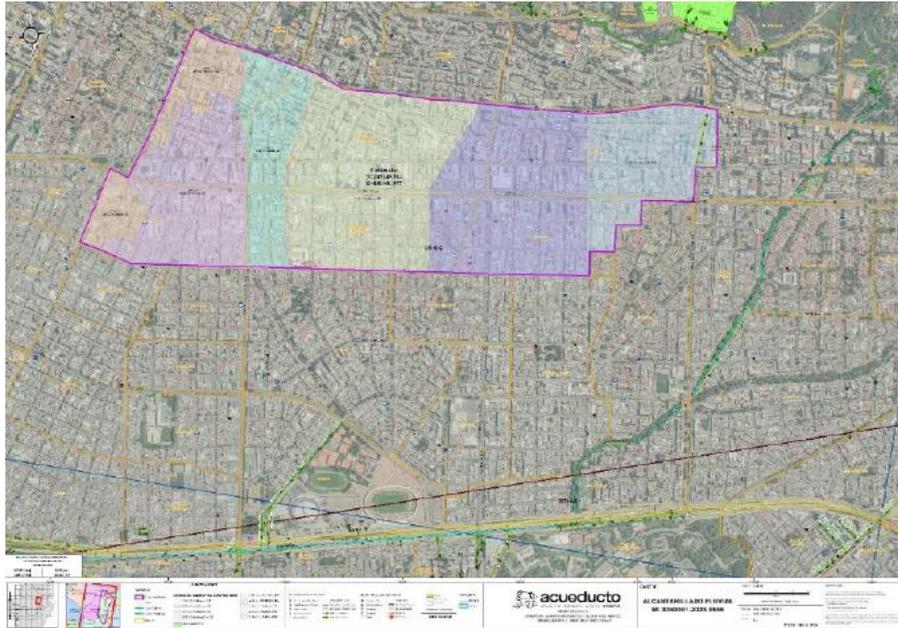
Redes locales de alcantarillado pluvial de la AECVI.
